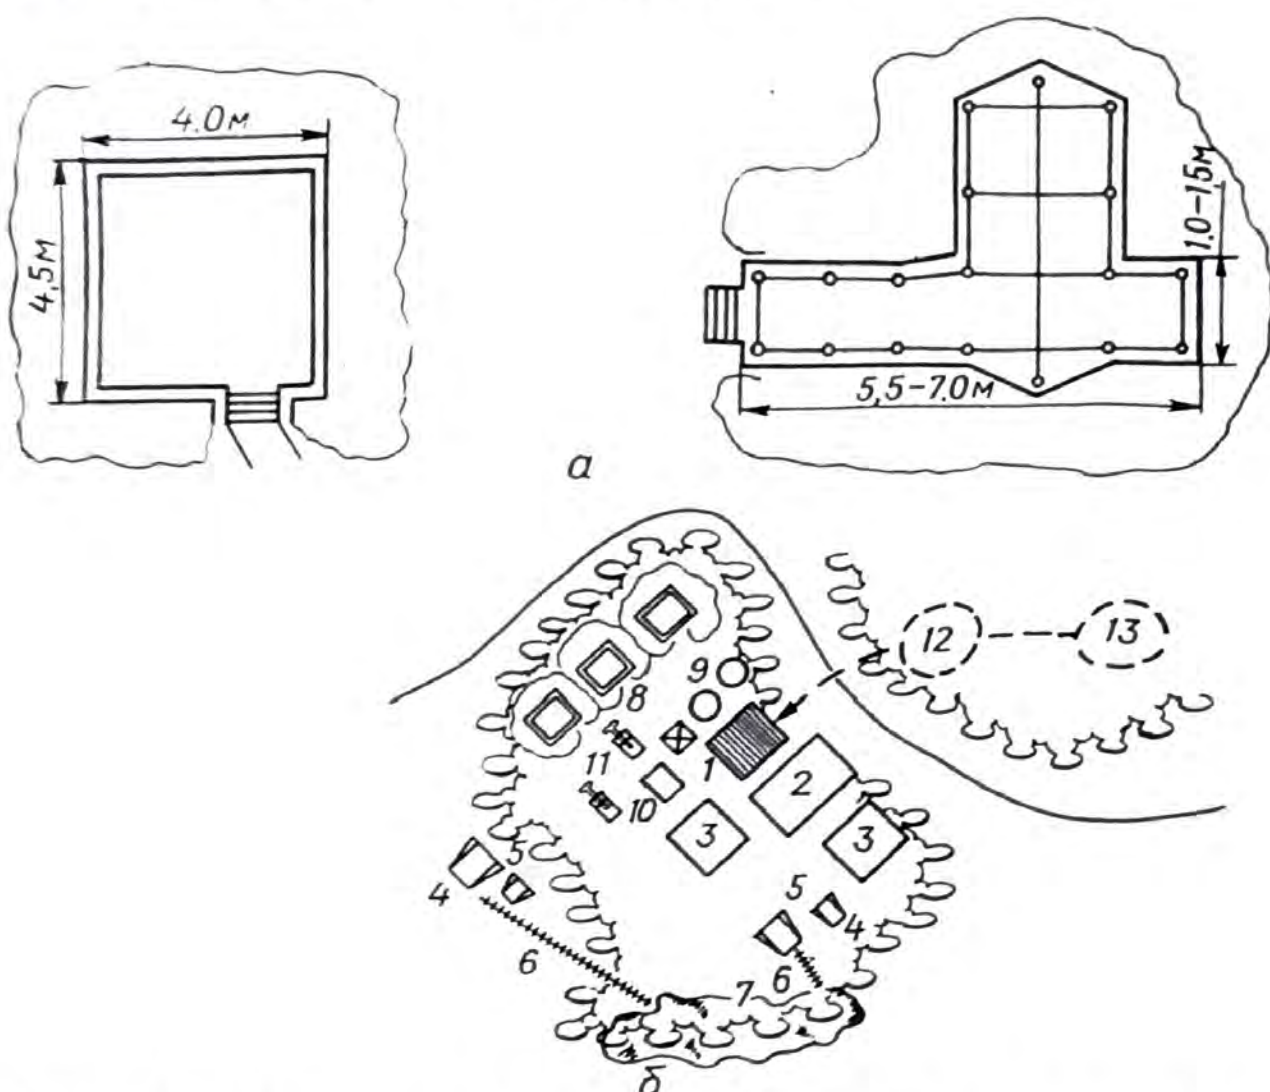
Схема котлованов (а) и строительной площадки при возведении укрытий (б):
